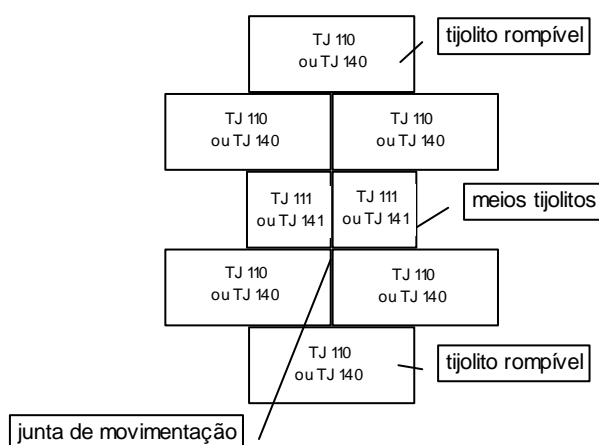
Croqui da elevação de uma junta de movimentação em parede externa, construída com os blocos TJ XYZ ou TJ XXZ
